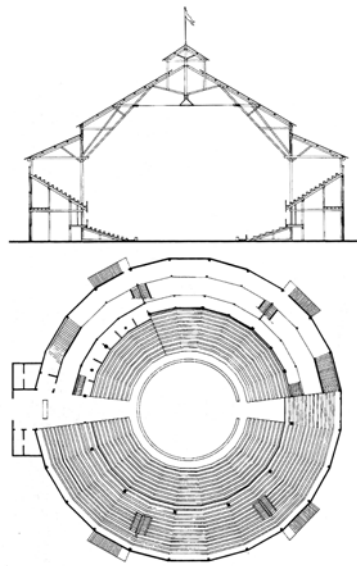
Zirkus Marseille Schnitt, Grundriss (13)
